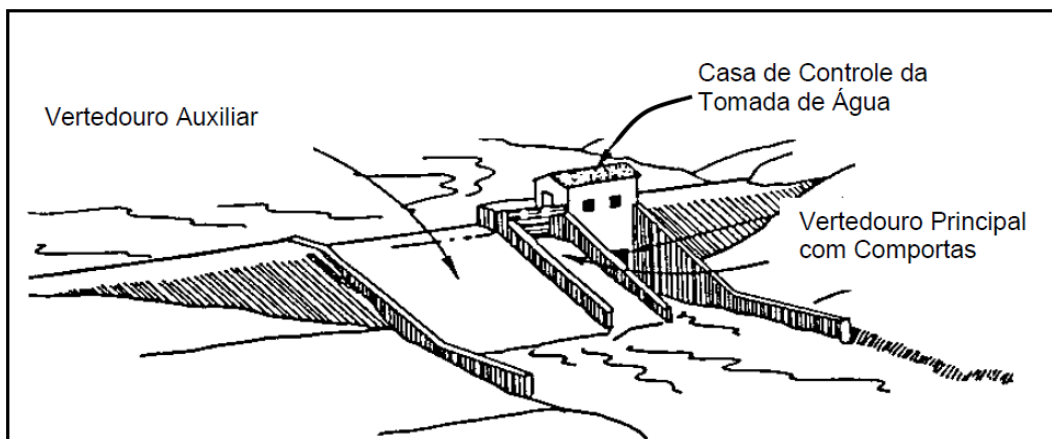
Croqui com os elementos estruturais de uma barragem de concreto.
